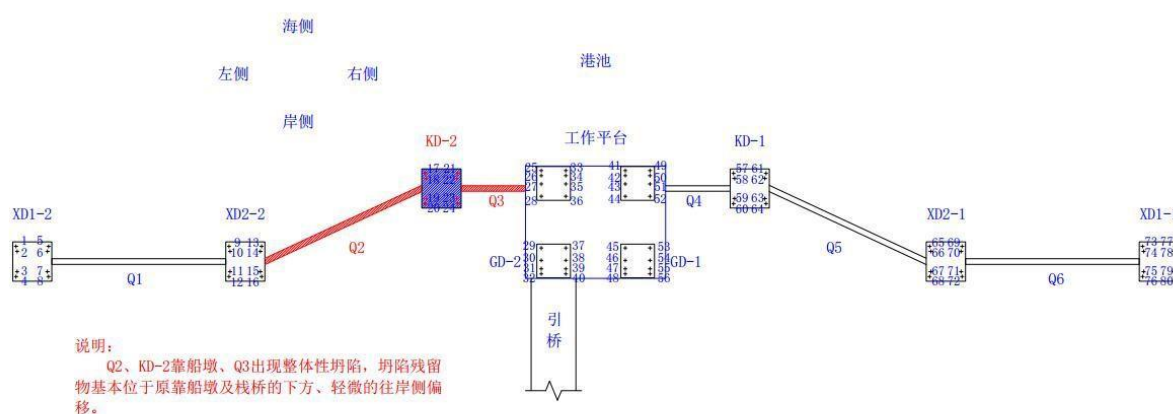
靠船墩及栈桥坍塌示意图（平面图）
